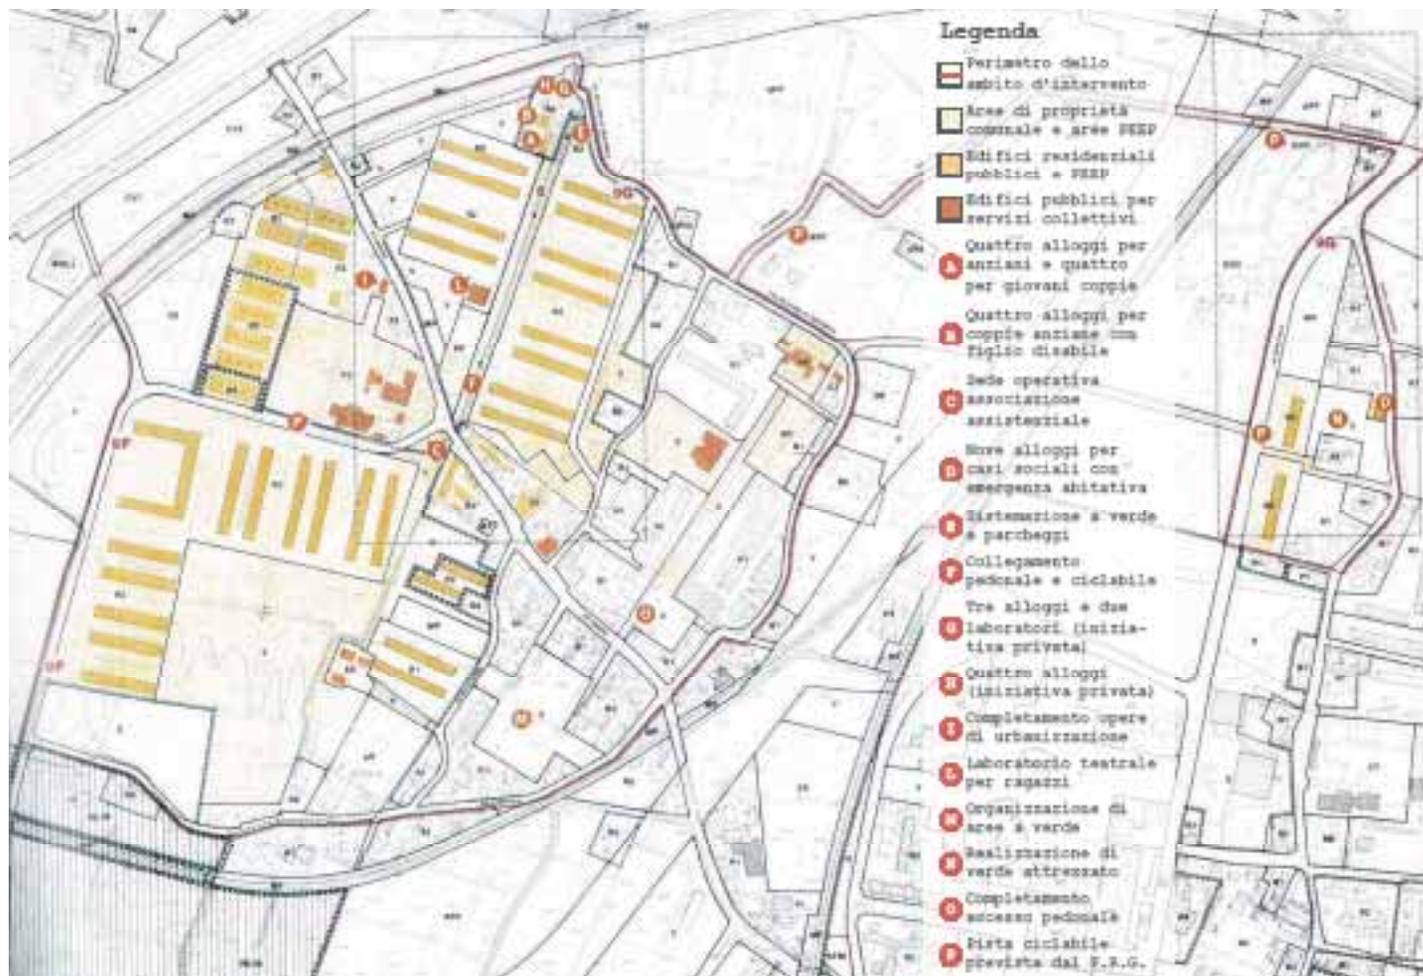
Planimetria della zona Pescarola-Beverara con indicati gli interventi previsti dal programma.
